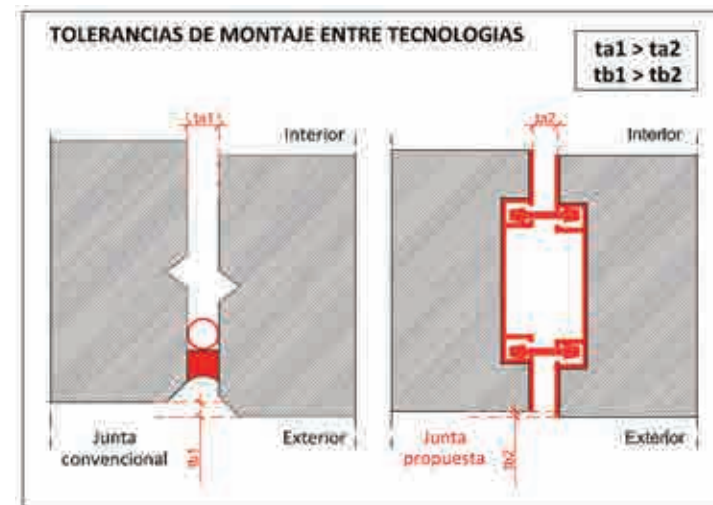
Disminución de las tolerancias y montaje inequívoco de los componentes
